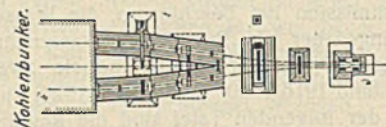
Grundriß der Bahn bis zum Kohlenbunker.
